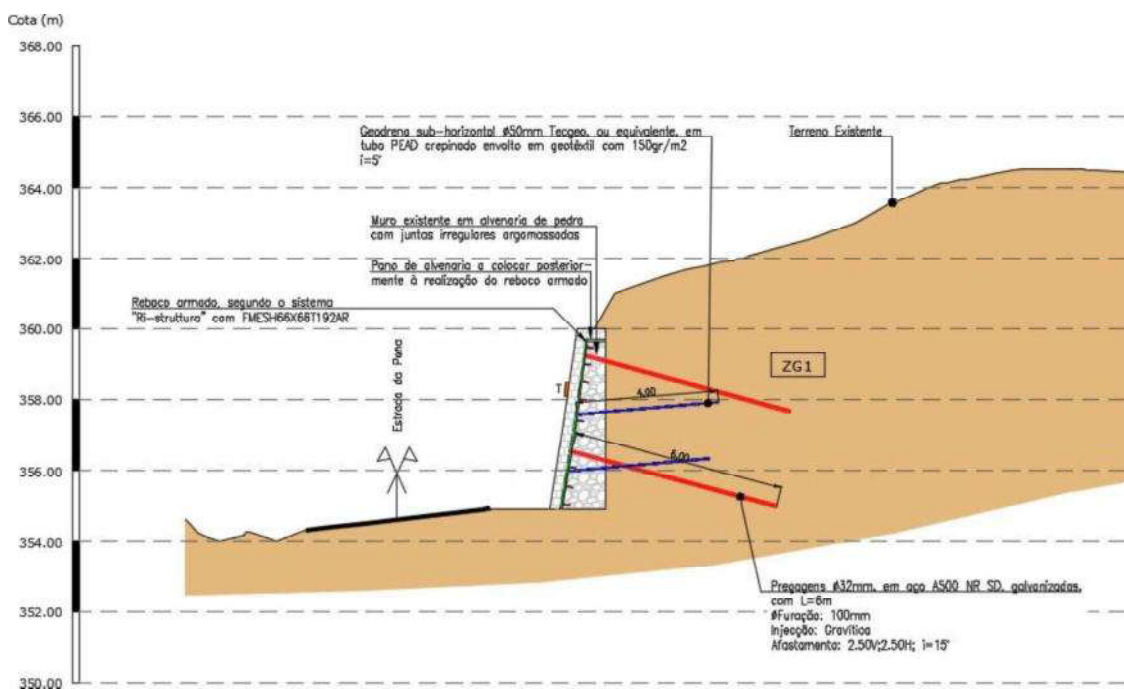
Corte tipo da solução de estabilização do muro e talude
